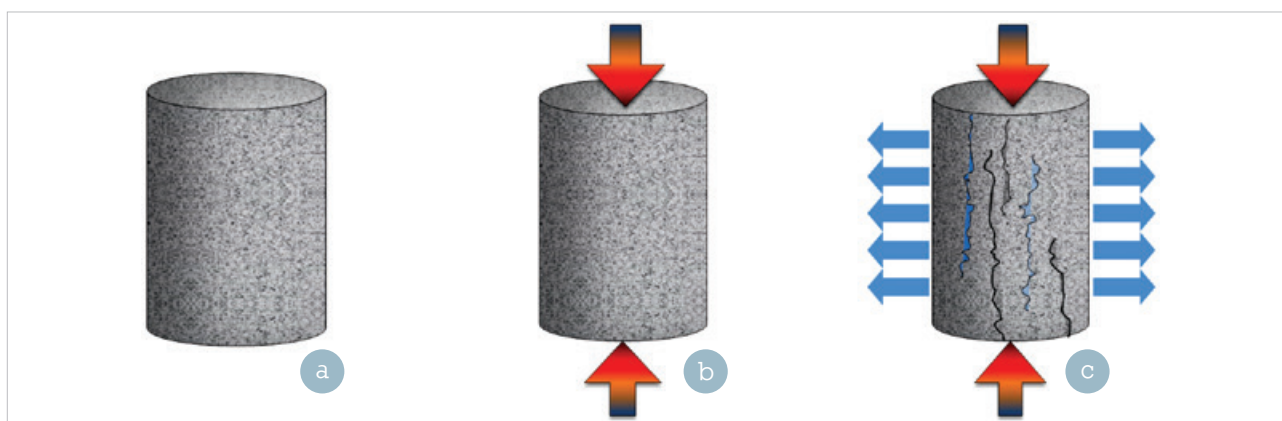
Influência do estado de tensão de compressão na orientação das fissuras induzidas por expansão interna do concreto
